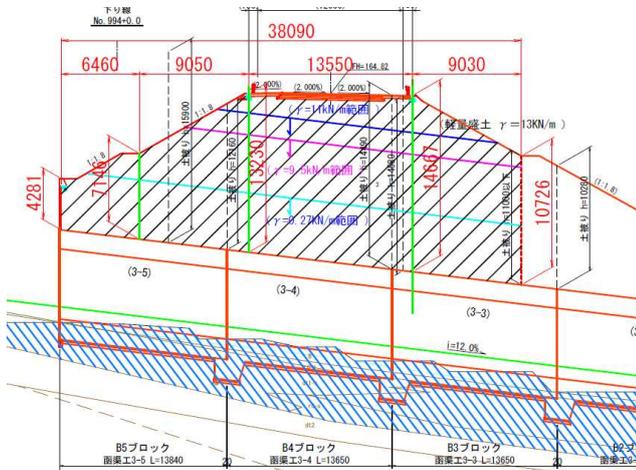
横断函渠部横断面図 (軽量盛土材の検討)
